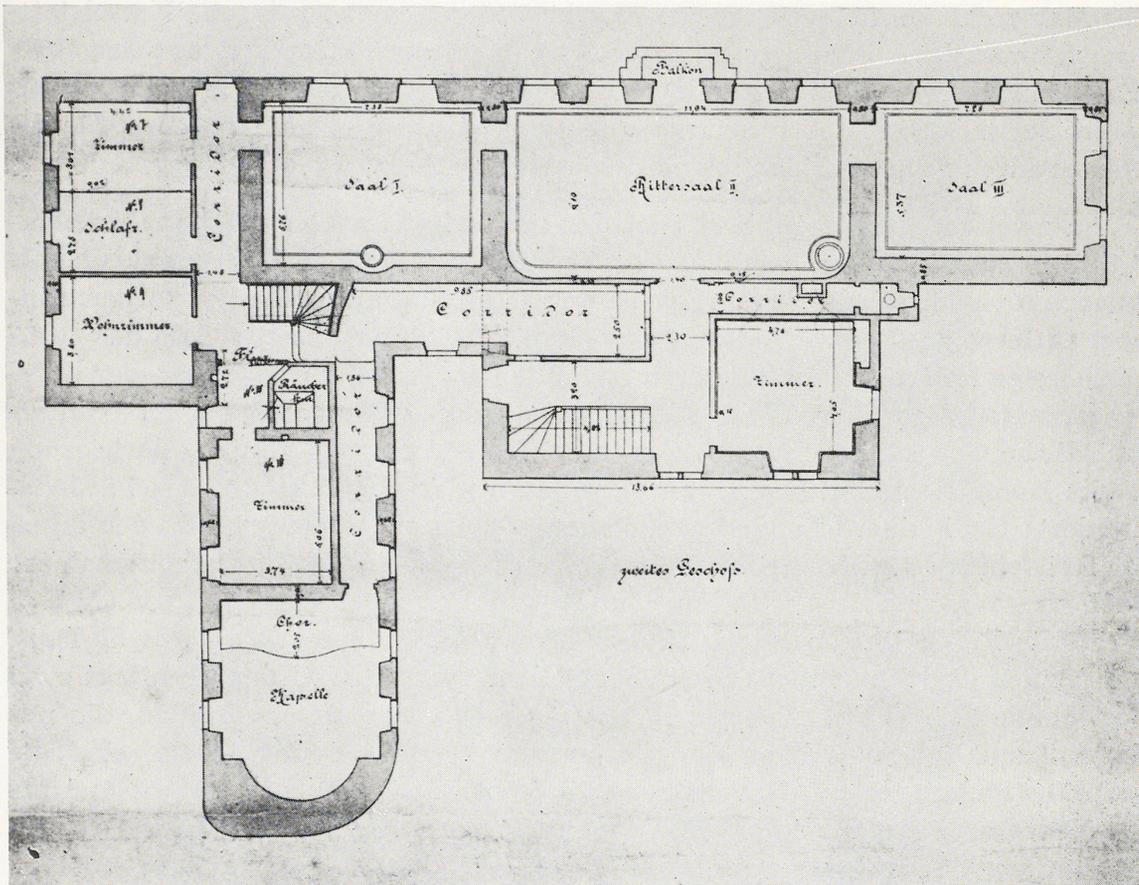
Bekond, Hauptgeschoßgrundriß um 1900 (P25)
